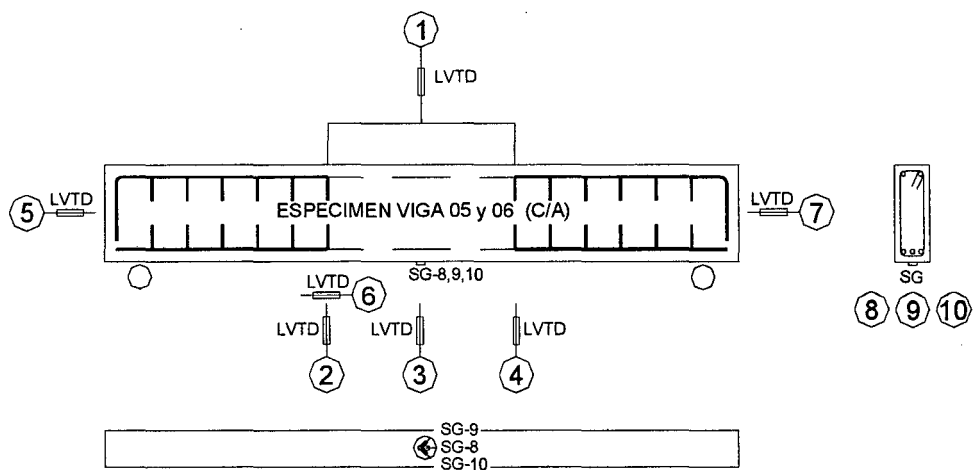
Ubicación de Transducer y Strain Gage en los espécimenes Viga 05 y 06 reparadas con inyecciones de Resinas Epóxicas
